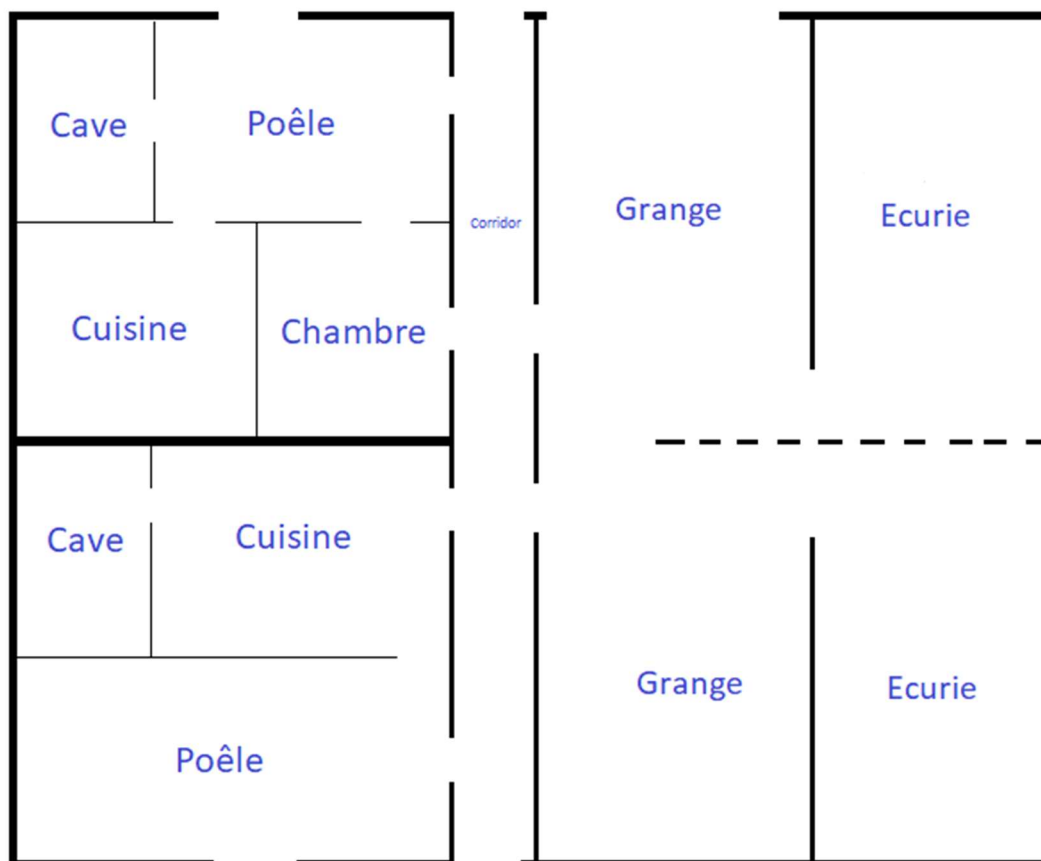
Plan du rez-de-chaussée de la maison des frères Dormoy
